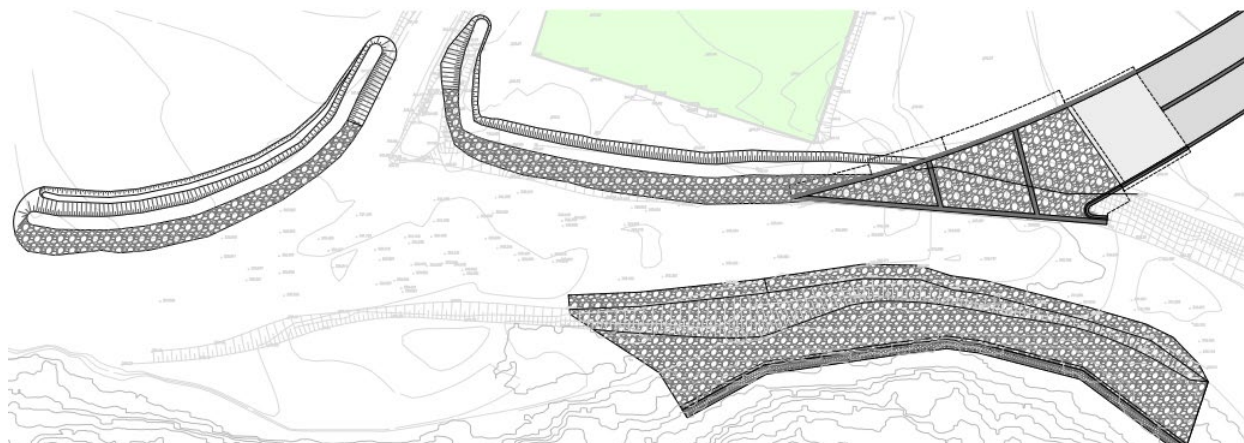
planimetri opere di restituzione e di protezione confluenza galleria di by-pass / Chiese
